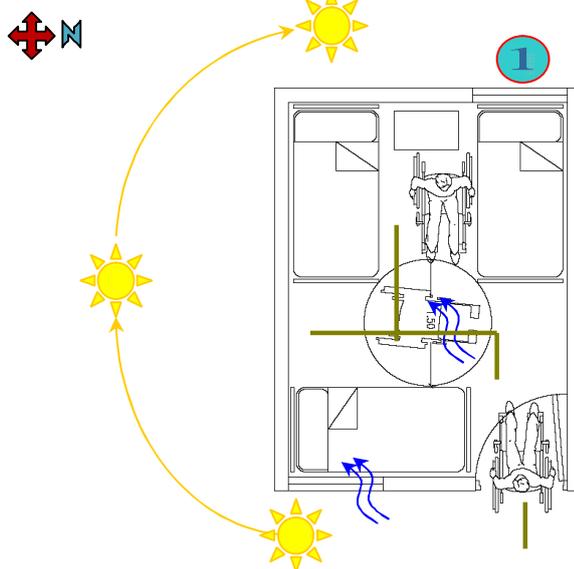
Planta Arquitectónica de dormitorios. (Pabellón de Mujeres)/ Fuente: Propia.
